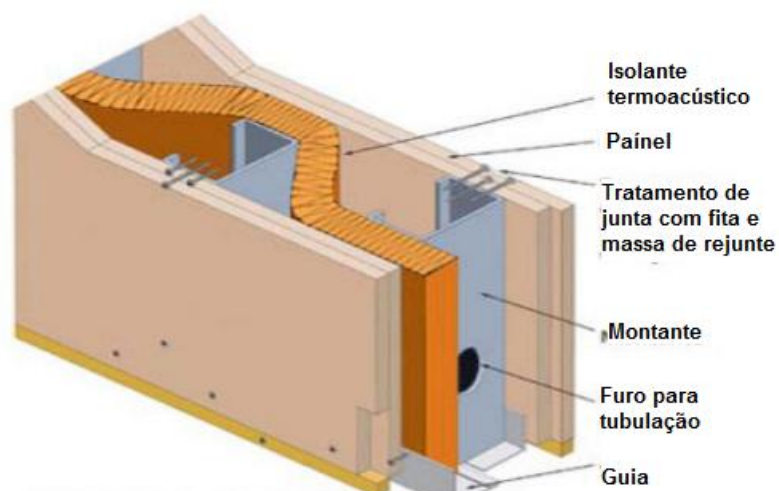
Esquema de montagem de parede de *Drywall* com material isolante
